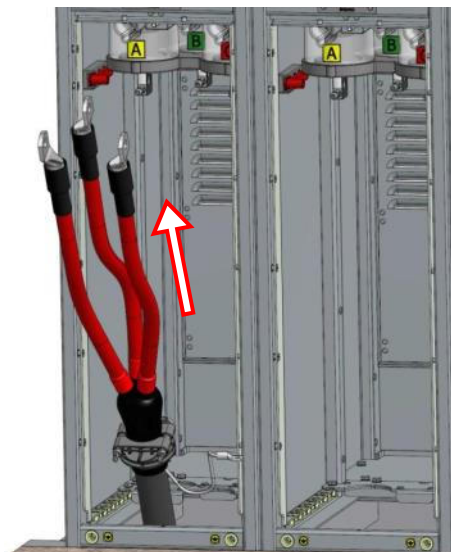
Подготовка трехжильного кабеля к монтажу
